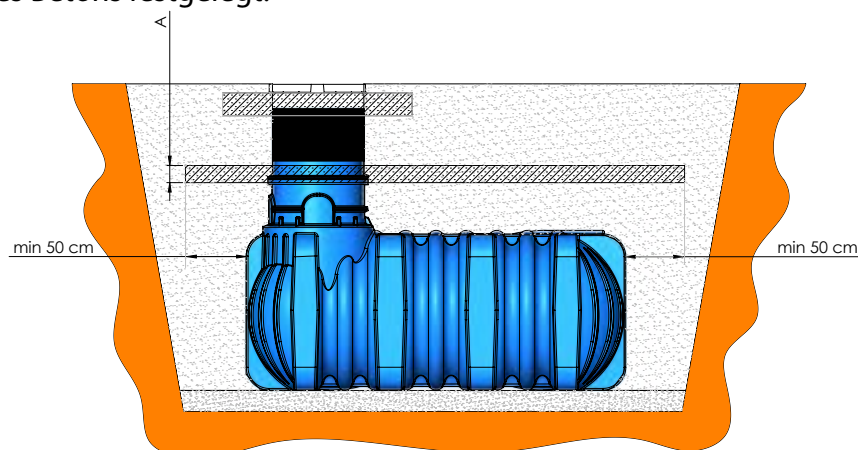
Einbau des Behälters unter befahrbare Flächen
